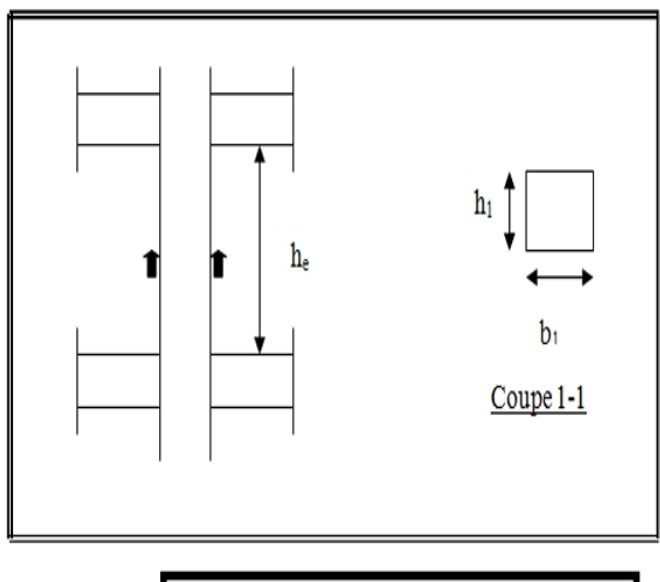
Coffrage des poteaux. Figure II.6. Dimensions des poteaux.
